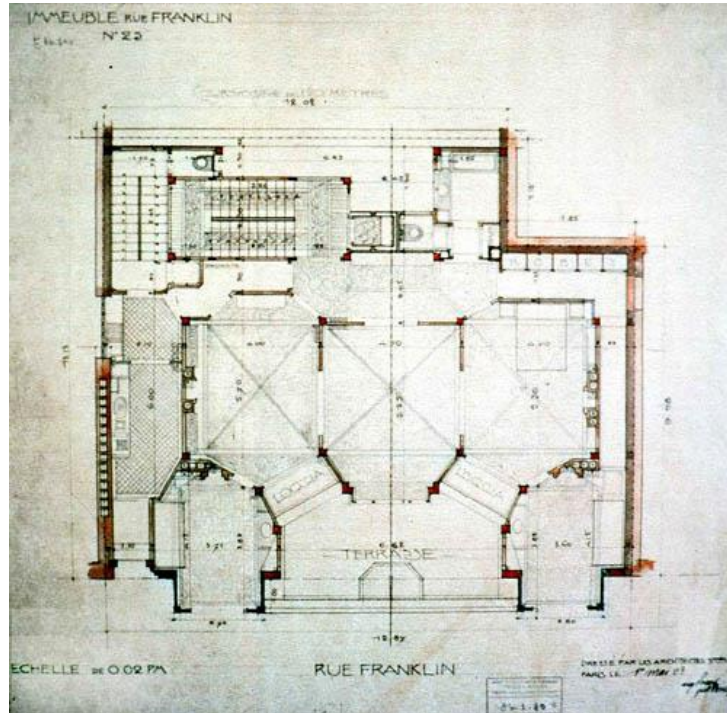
Edifício 25 da rua Franklin 29 – Planta
